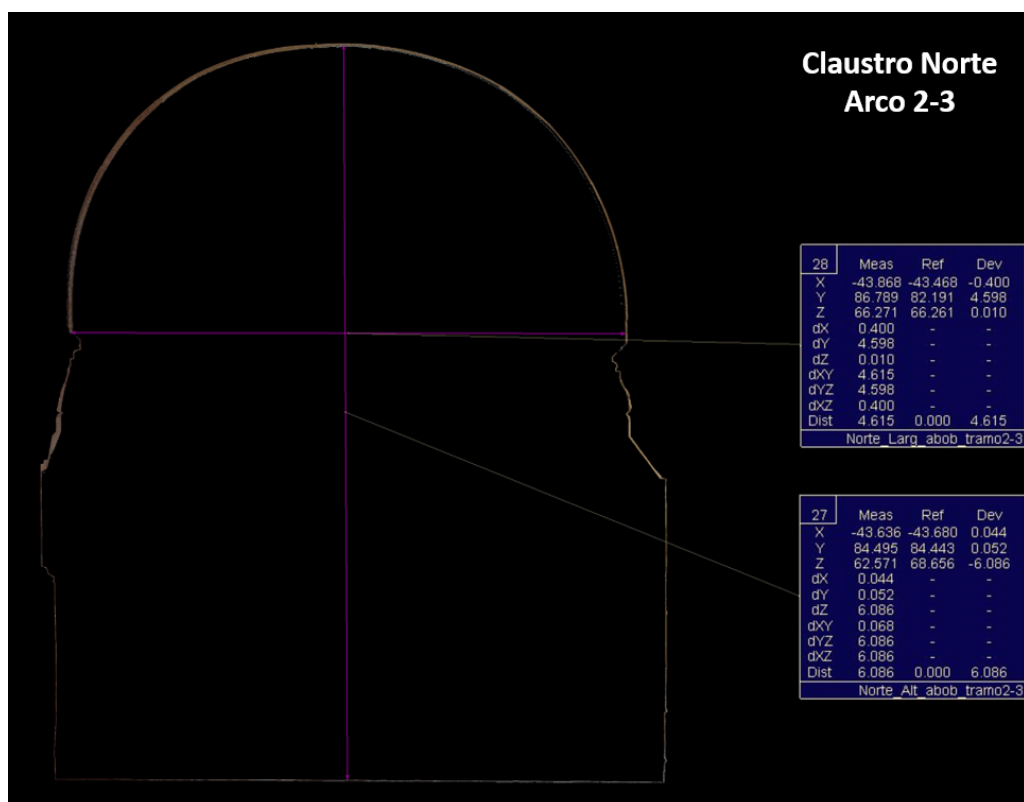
Corte transversal do Arco 2-3 do claustro Norte de D. Dinis.
